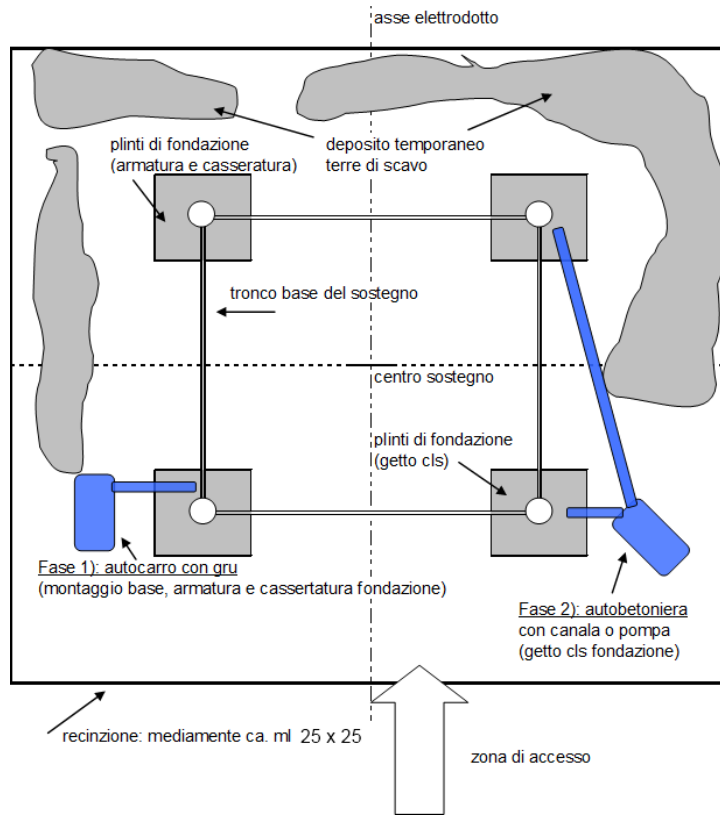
layout tipo dell'area sostegno (getto e montaggio basi)
